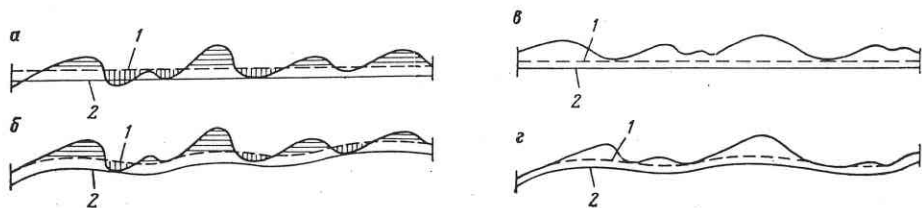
Укладка трубопроводов в пустыне с учетом рельефа:
